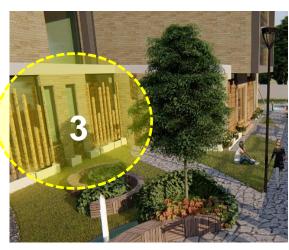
brise solaire verticale au niveau de l'équipement. Source : auteurs
